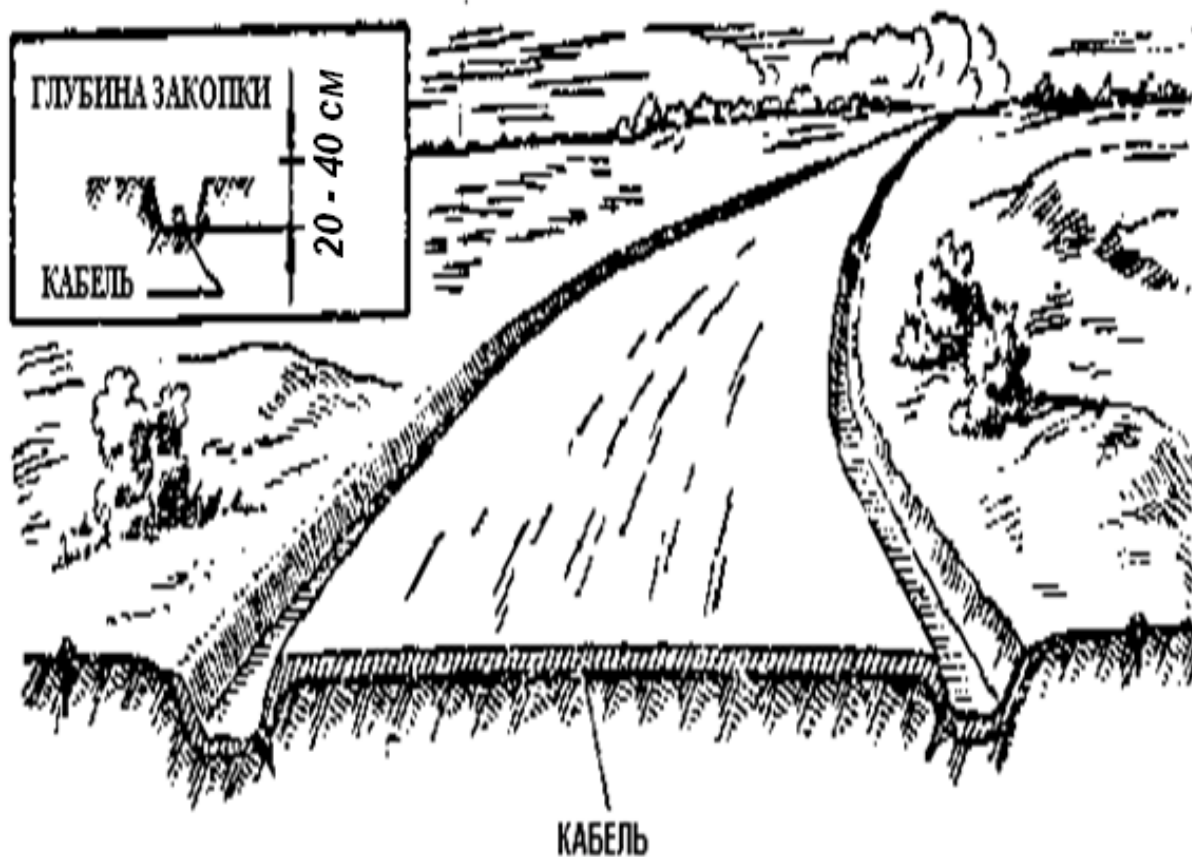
Прокладка кабеля через грунтовую дорогу
